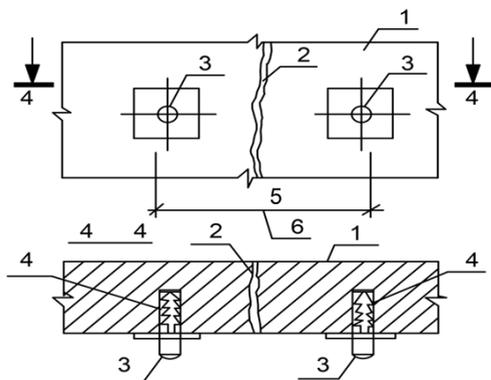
Трещиномер для длительных наблюдений: 1 – строительная конструкция; 2 – трещина; 3 – марка, представляющая цилиндр из нержавеющей стали с полушаровой головкой, укрепленный на квадратном фланце из листовой стали; 4 – анкер, приваренный к фланцу (служит для крепления марки к конструкции); 5 – расстояние между марками, измеряемое штангенциркулем
